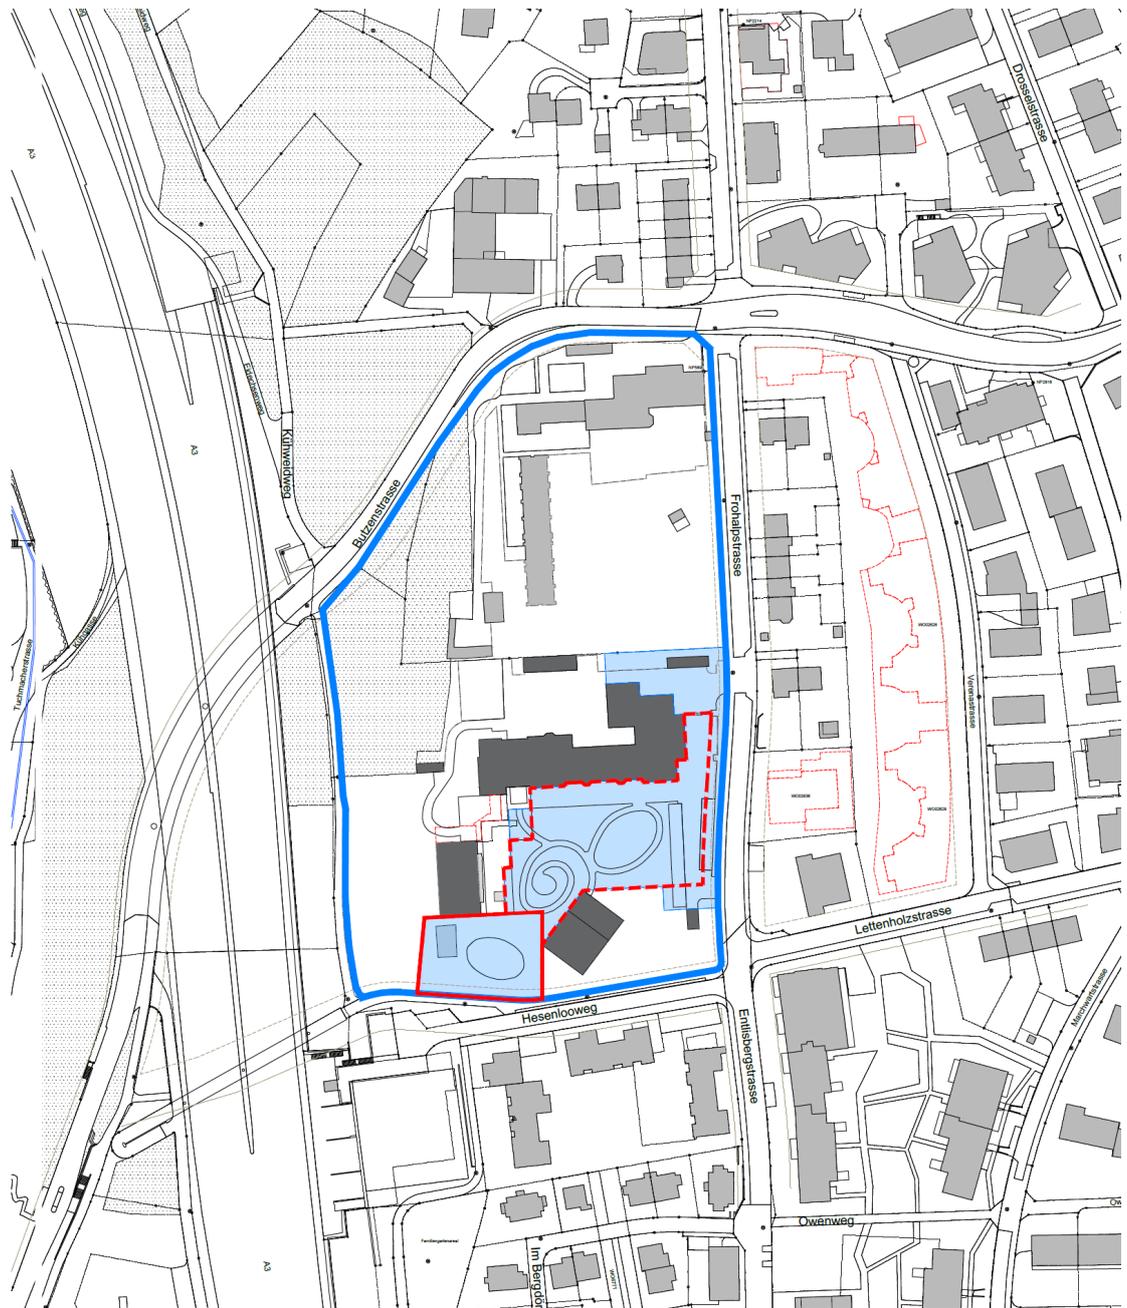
Perimeterplan, ohne Massstab, genordet, Quelle: GIS-ZH, Kanton Zürich
